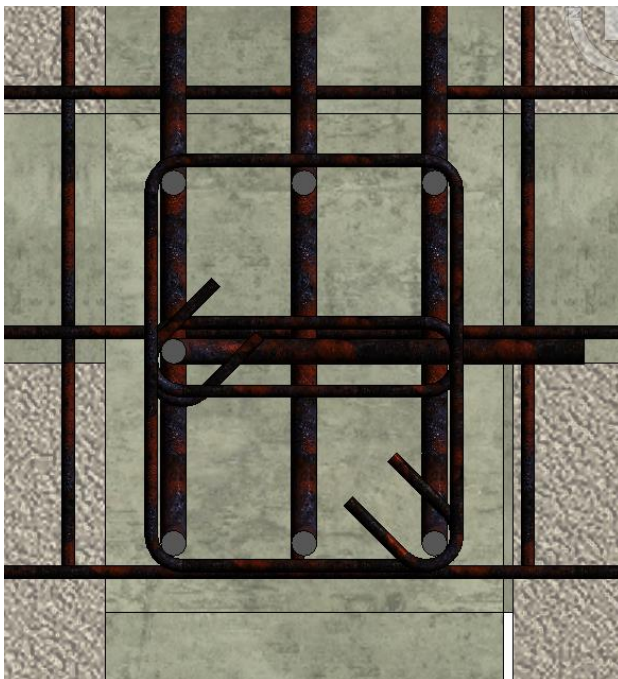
Vista Corte de Columna C-1 (Fuente: Elaboración Propia).
